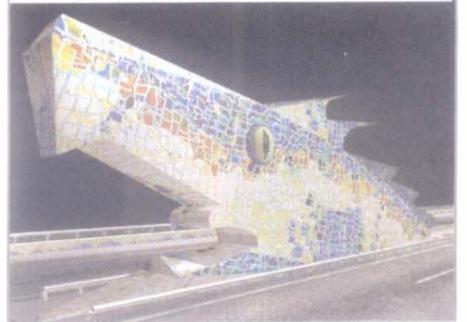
Perspectiva de la cabeza del Dragón incluida en el Proyecto de Construcción.
